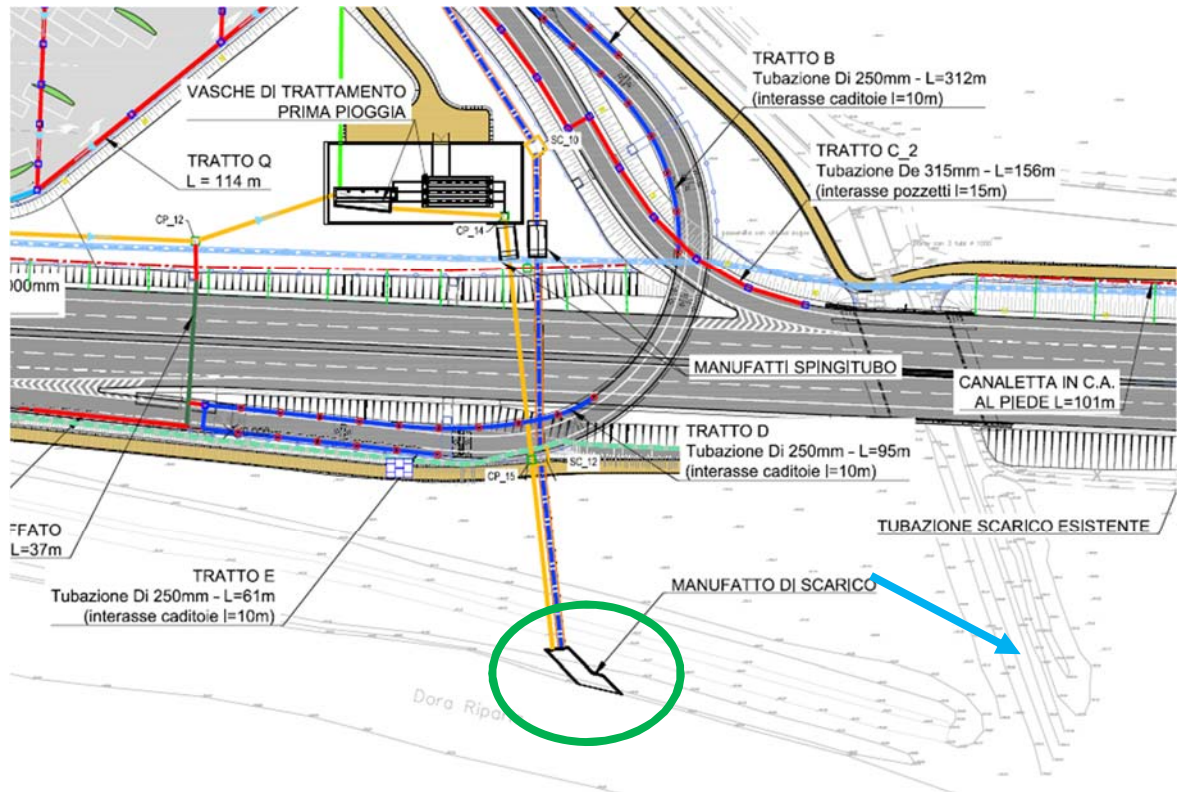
Stralcio planimetrico del punto di scarico in Dora dell'impianto di trattamento acque (cerchiato in verde). La freccia blu indica il ramo di scarico del canale NIE
